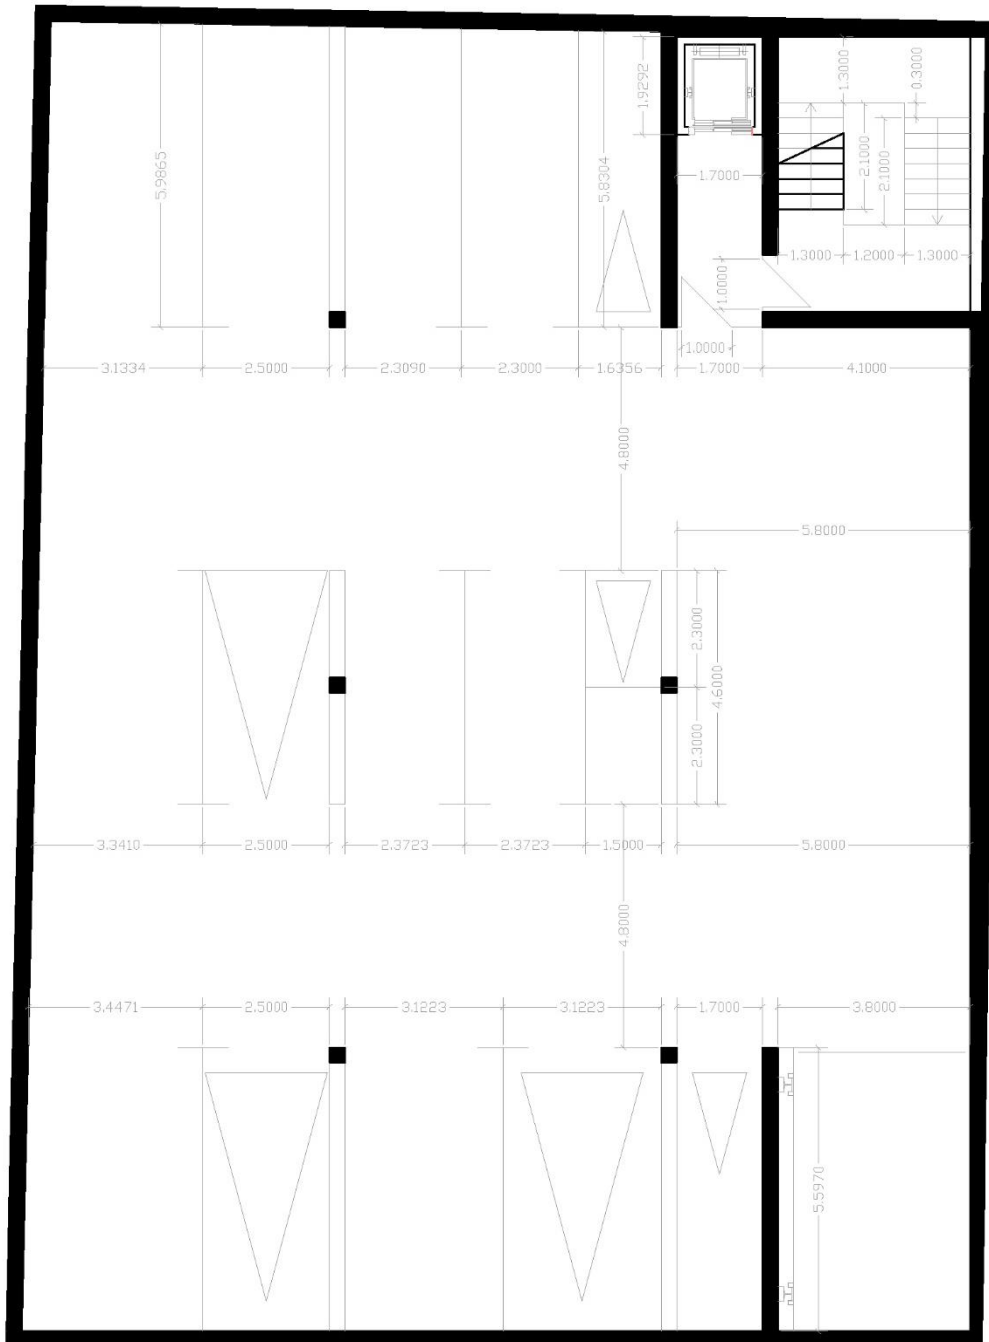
Encaje de proyecto, plantas sótano -1,-2,-3. Fuente: Elaboración propia.
